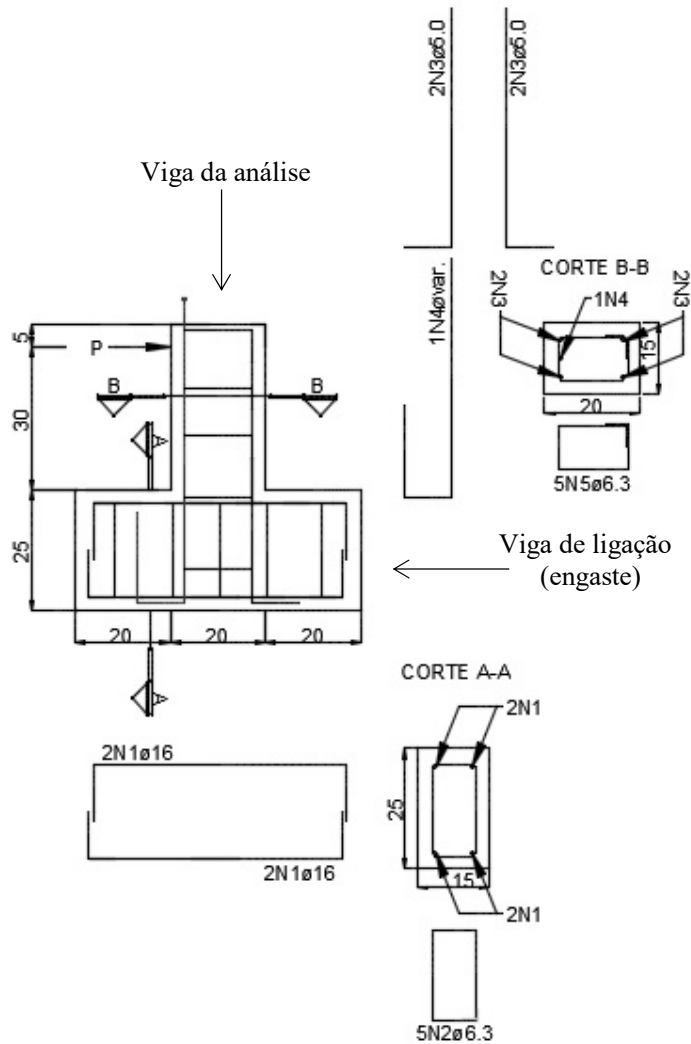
Detalhamento da armadura das vigas (dimensões em cm).
